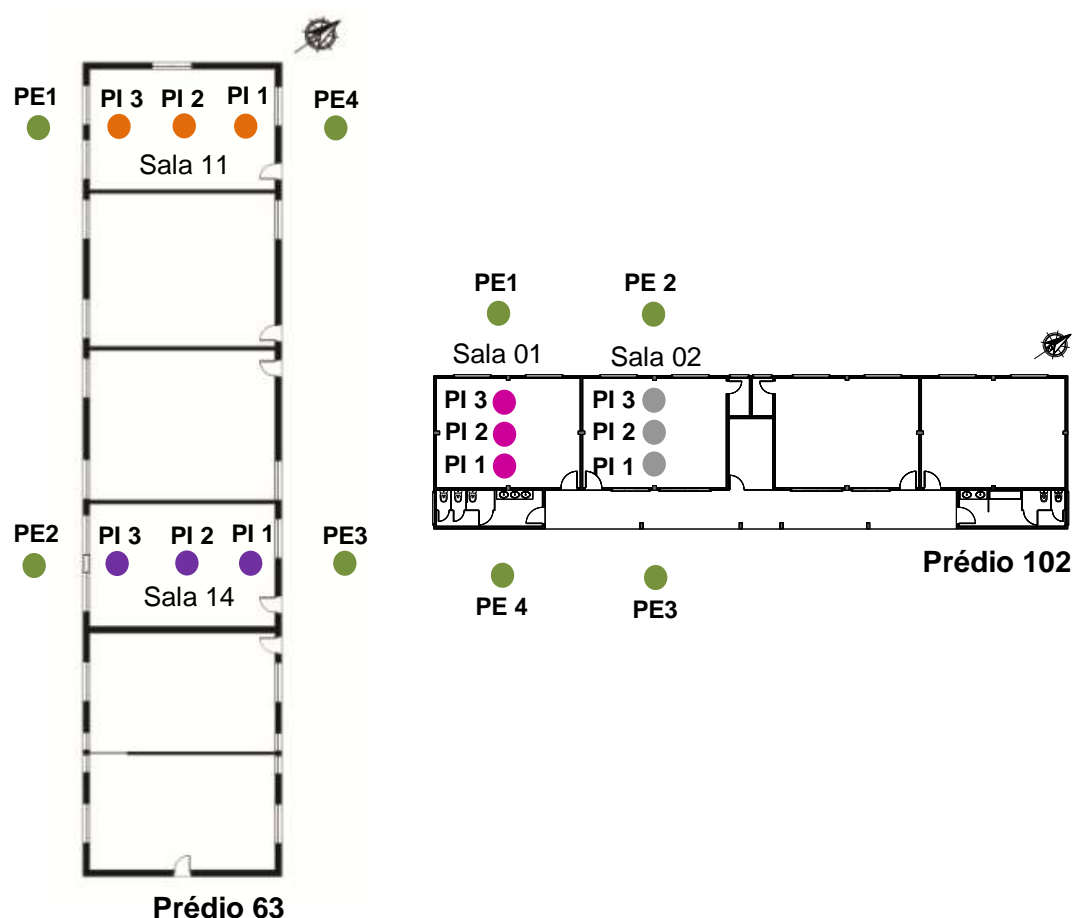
Planta Baixa dos prédios 63 e 102, respectivamente, com localização dos pontos de medição.
